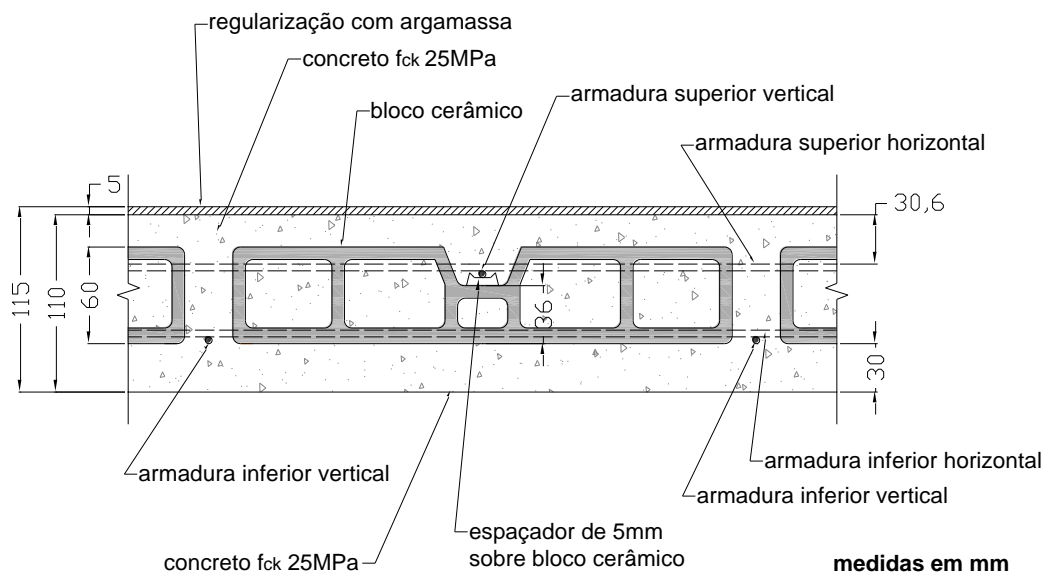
Corte esquemático de um painel com espessura de 115mm (dimensões sem escala) – painel empregado nas classes I e II de agressividade ambiental (cobrimento mínimo de concreto estrutural de 30mm)
